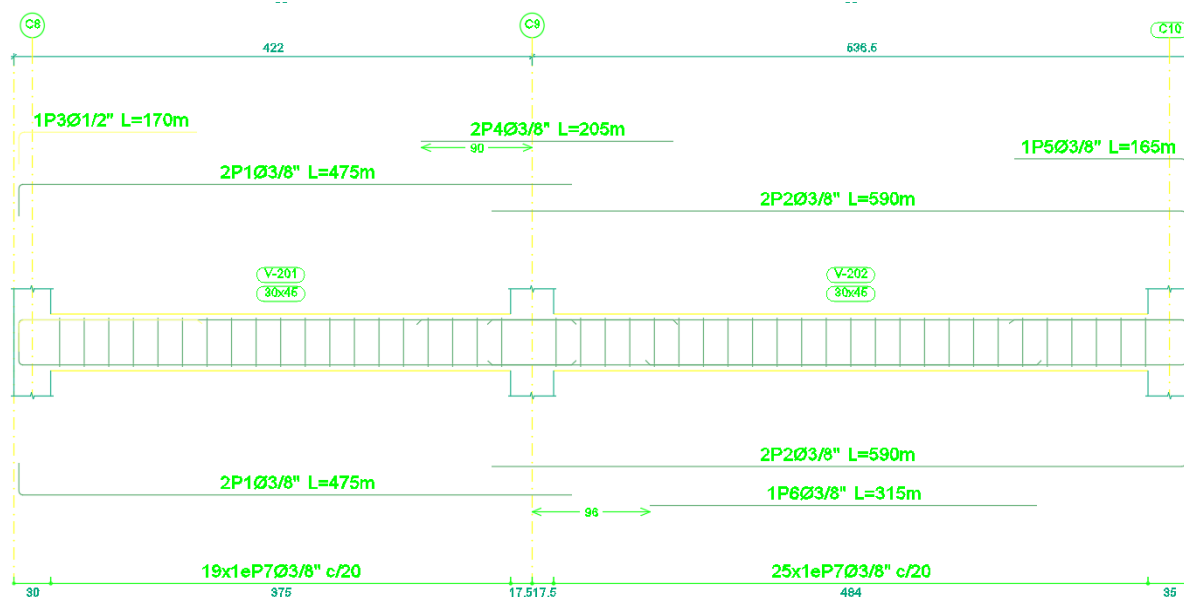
Detalle vigas de placa 1 Nivel 1.
